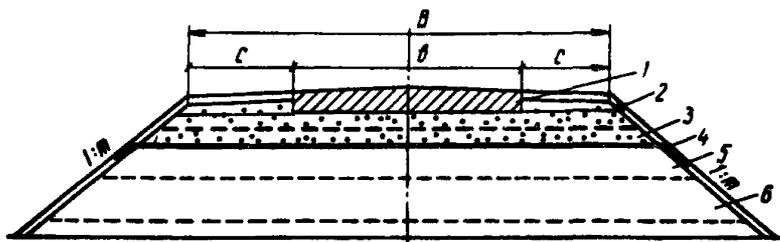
Конструкция насыпи из грунта повышенной влажности с прослойками из геосетки в пределах морозозащитного слоя и геотекстиля на контакте этого слоя с грунтом повышенной влажности: 1 - покрытие; 2 - морозозащитный (дренирующий) слой; 3 - армирующий элемент из геосетки; 4 - прослойка из геотекстиля; 5 - рабочий слой из грунта повышенной влажности с $K_y \geq 0,93$; 6 - тело насыпи из грунта повышенной влажности
